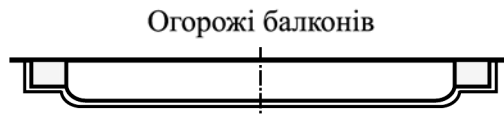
План балкону палацу Міра (вул. Вірменська, 13)
